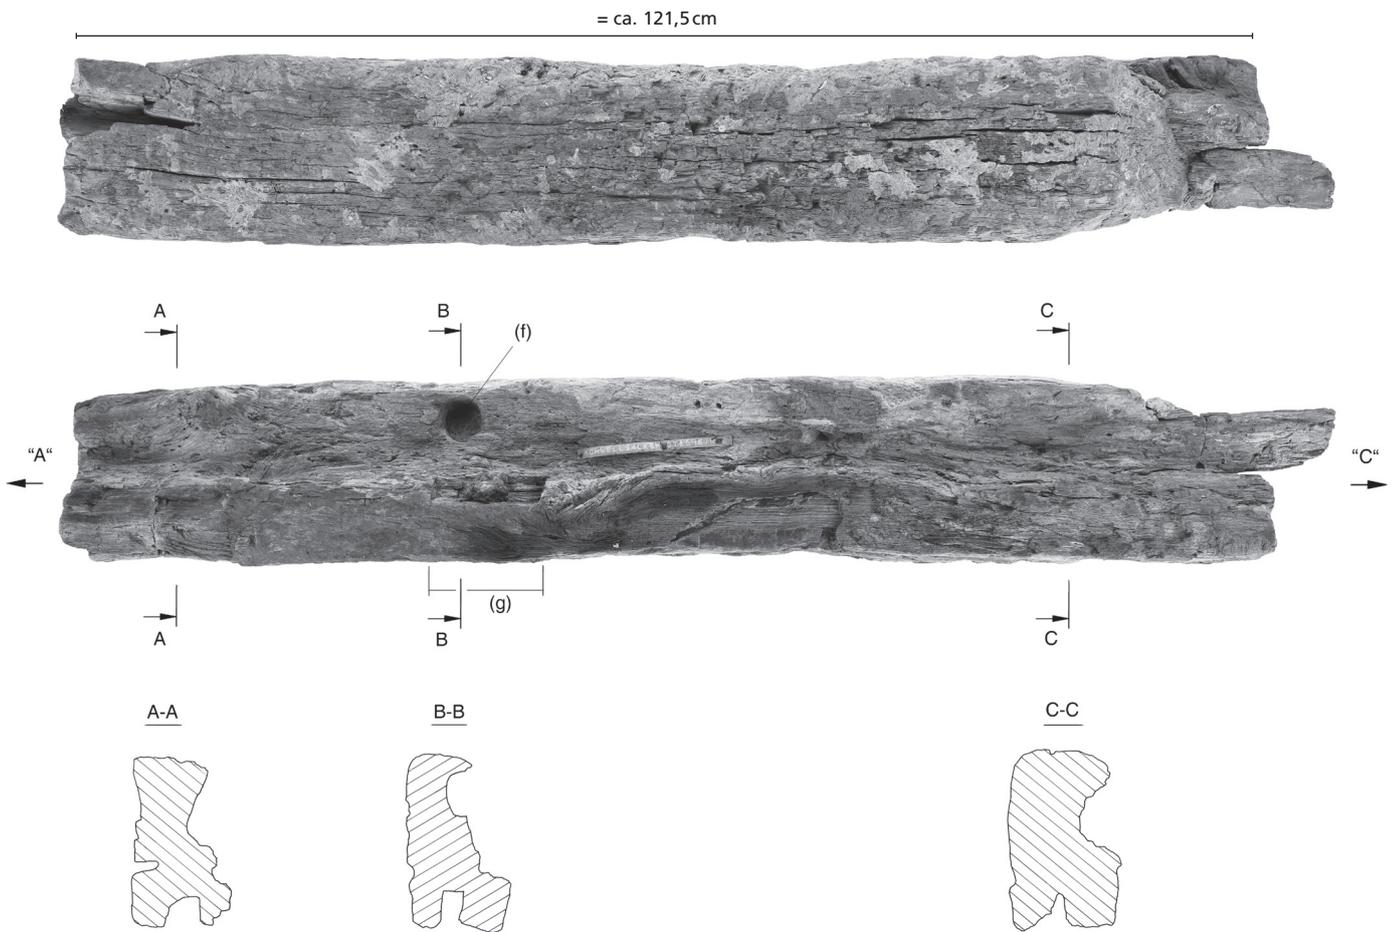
Schwellbalken einer Fachwerkkonstruktion. Bruchstück B.
